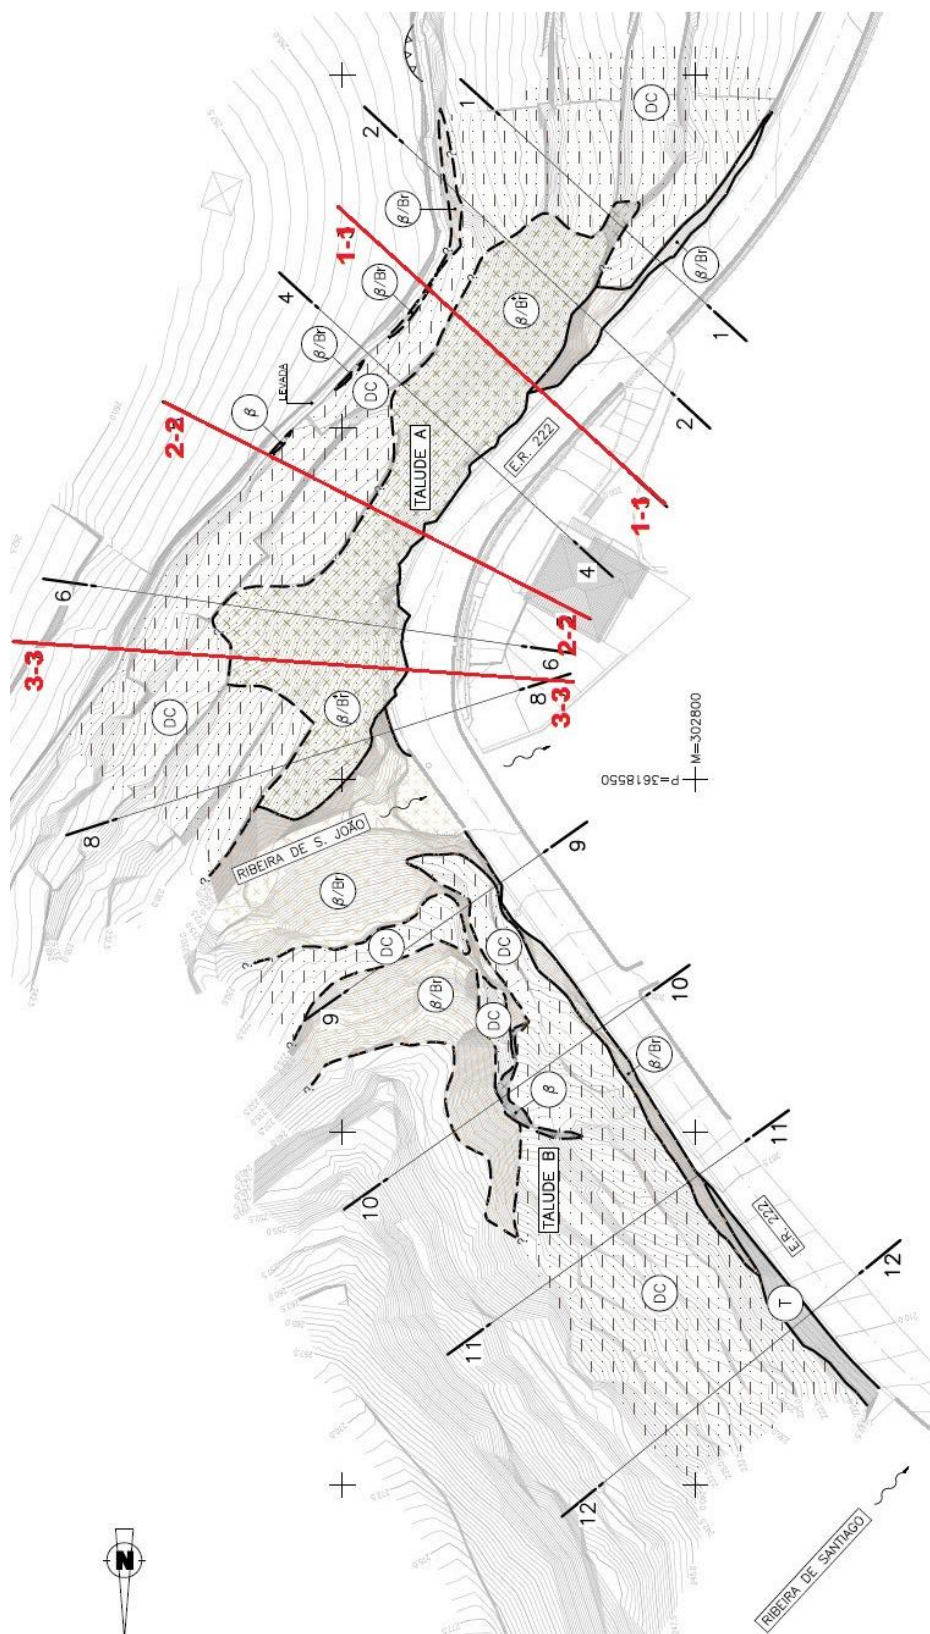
Planta geológica (adaptado de Cenorge, 2010)
